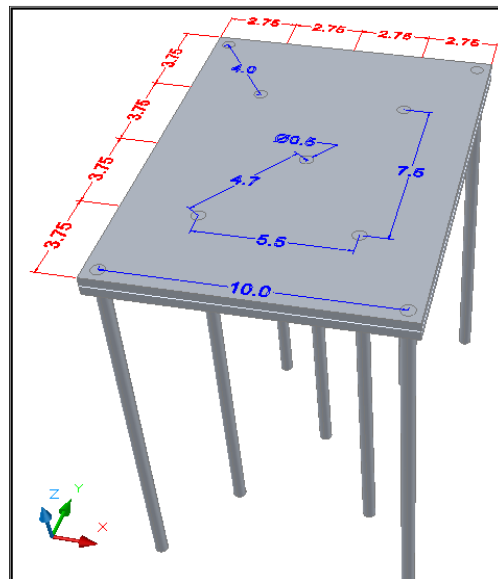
Vista de la superestructura con la cimentacion profunda
